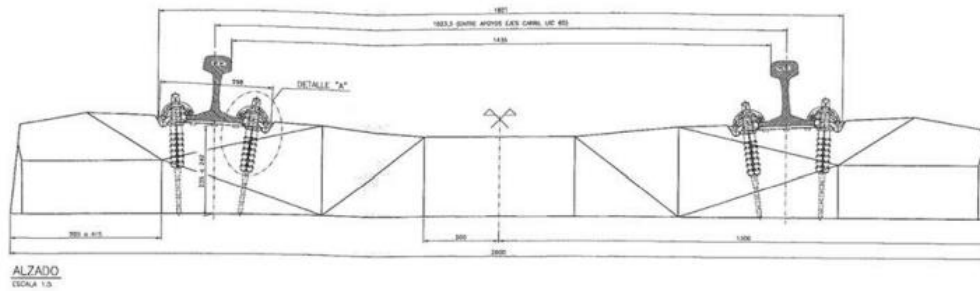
Travesía AI04 (Vista alzado). [2]
